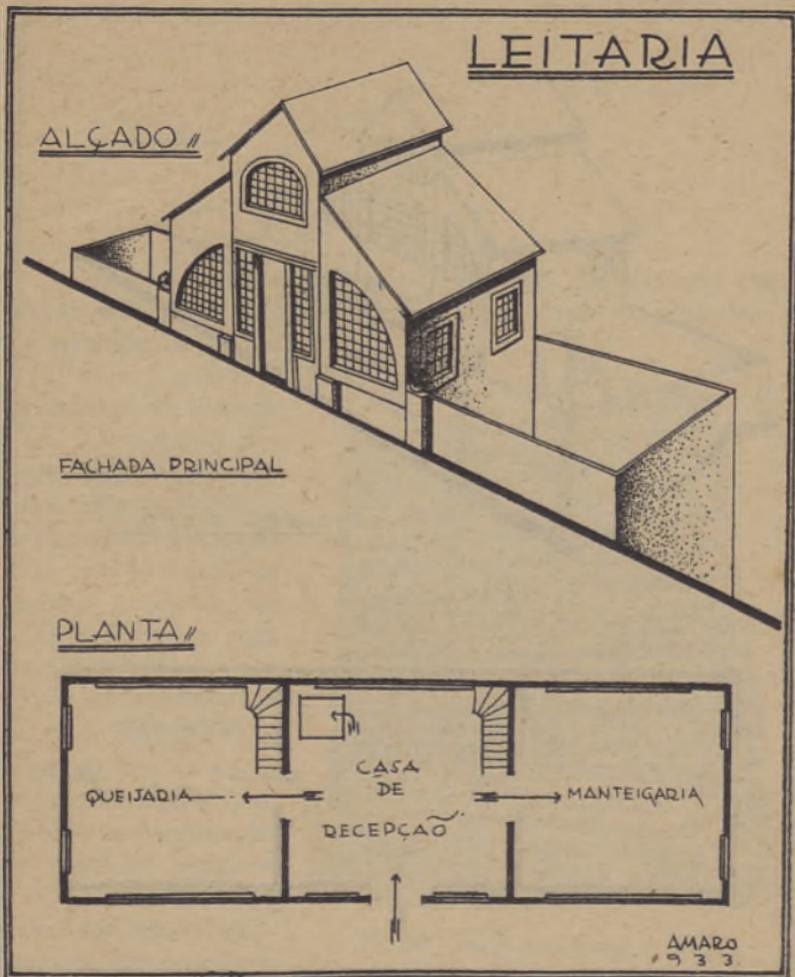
Alçado e planta para uma leitaria. Fachada principal
